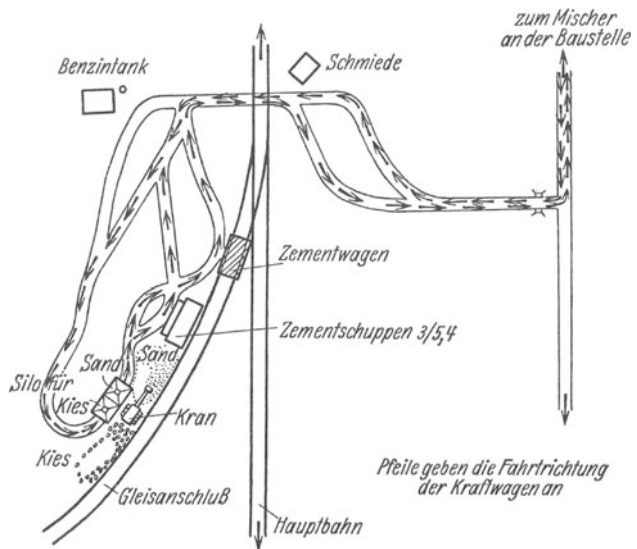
Baustofflager- und Verteilungsstelle für den Bau einer Betonstraße.
